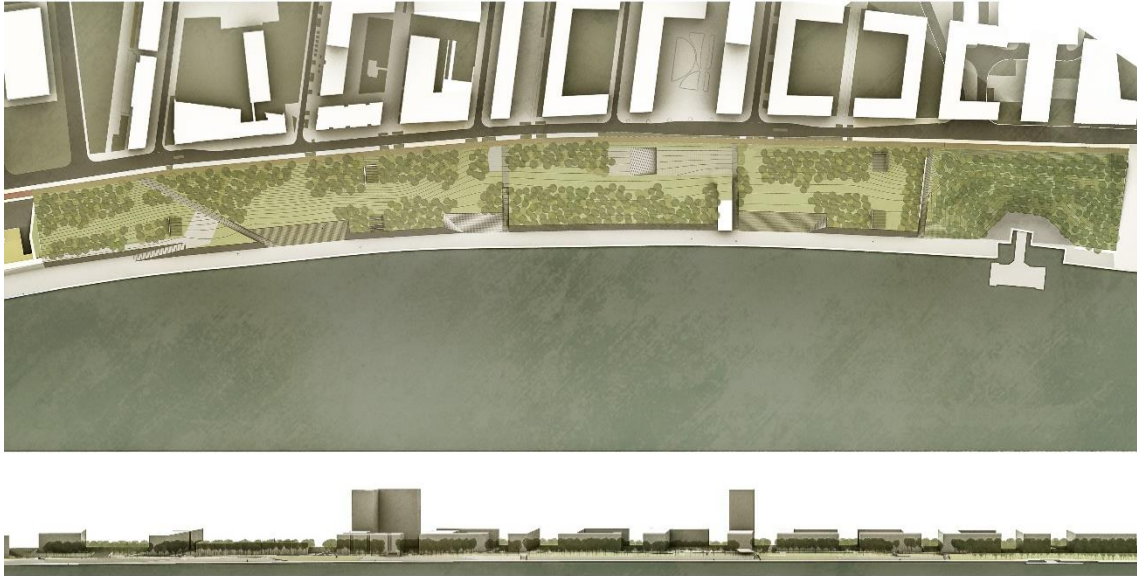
Plano geral e corte - Projeto de SNZ – Proap
